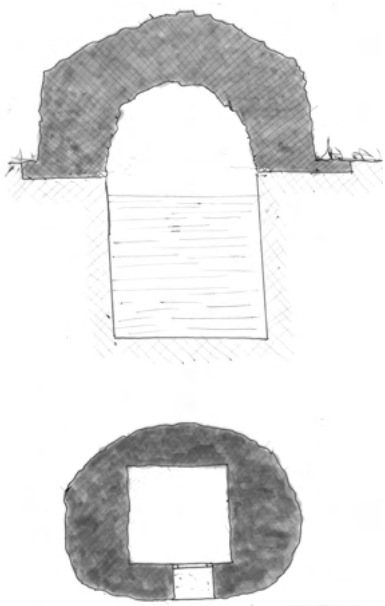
Dibujo de elaboración propia la sección en alzado y planta de una cisterna.
